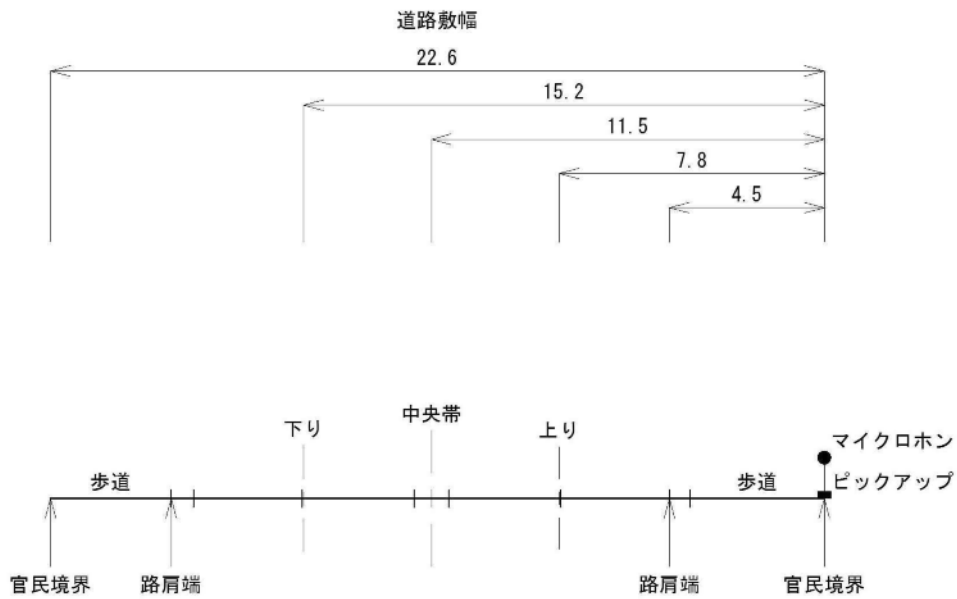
(2) 調査地点道路断面図(単位 : m)
